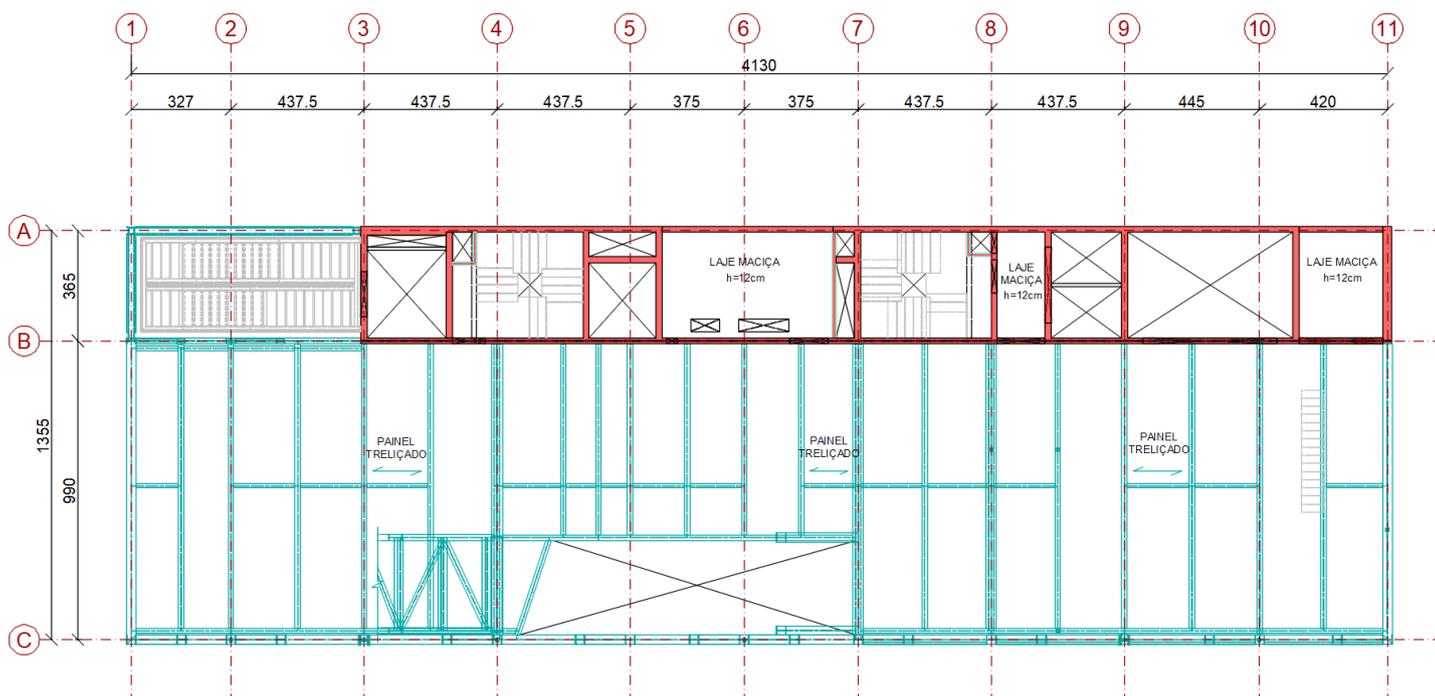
Planta de Arquitetura – Terceiro pavimento: auditório, foyer
